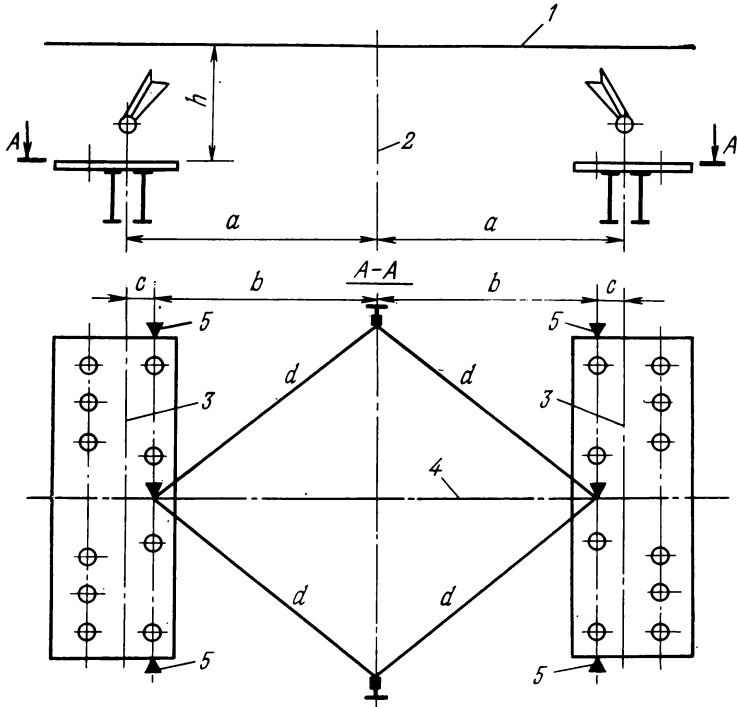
Схема установки опорных балок для посадочных кулаков:
